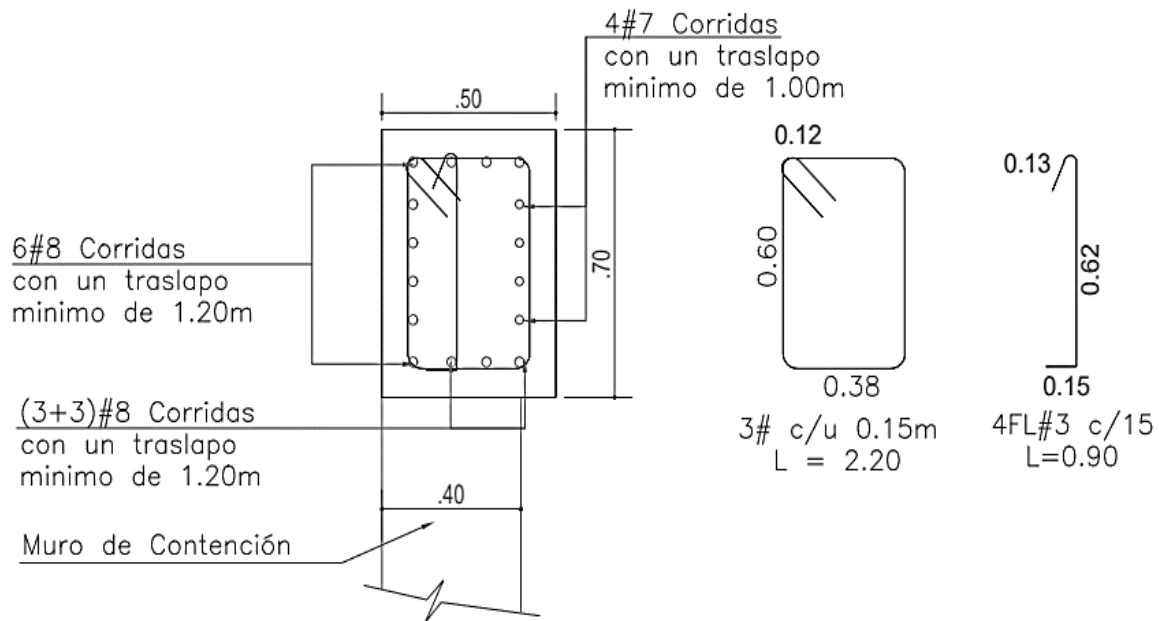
Detalle viga sobre muro. Fuente: Diseño estructural.
